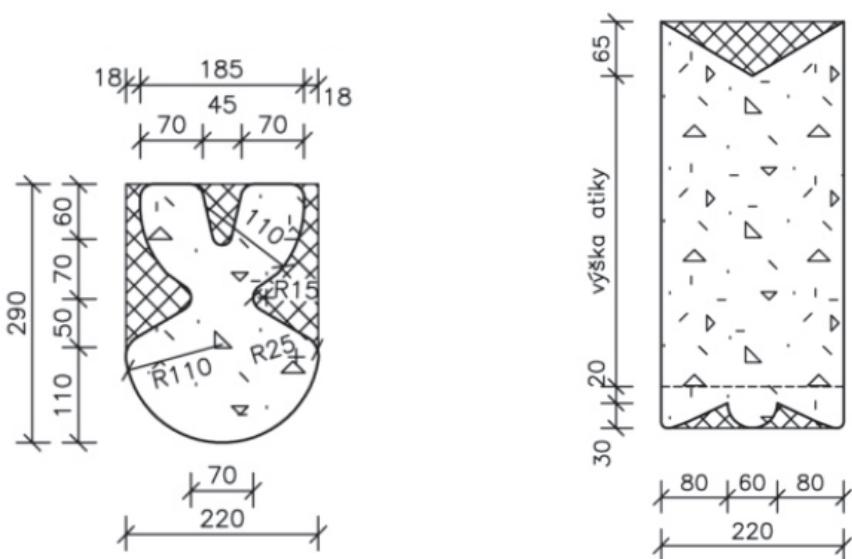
universální tvarovka 3 (převzato z [7])
